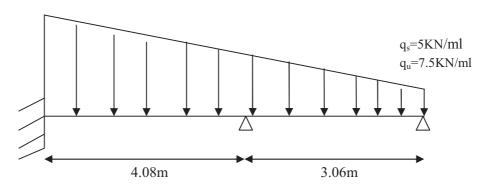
Schéma statique de mur plaque dans le sens x-x
